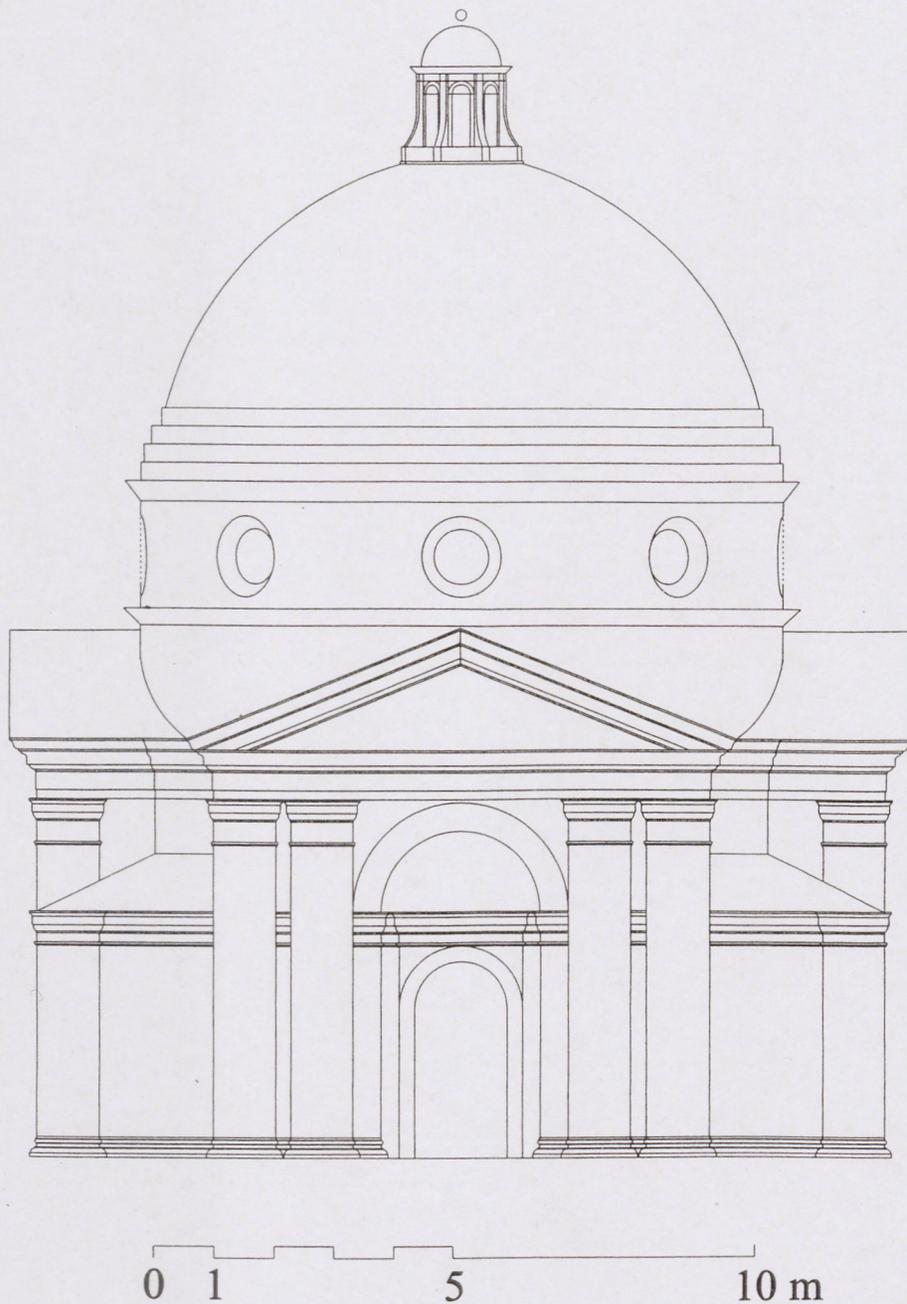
Ricostruzione ipotetica della facciata del progetto U 1050 A (disegno H. Schlimme)
